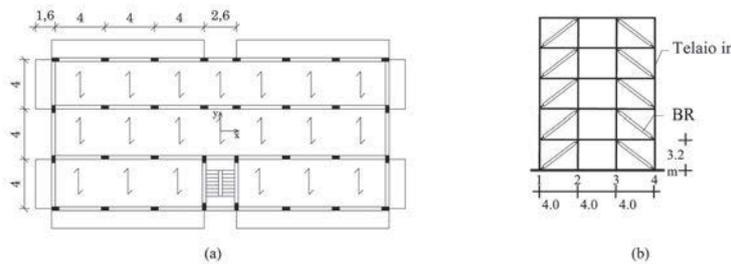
Pianta dell'edificio adeguato (a) e telaio in c.a. con BRBs (b)
